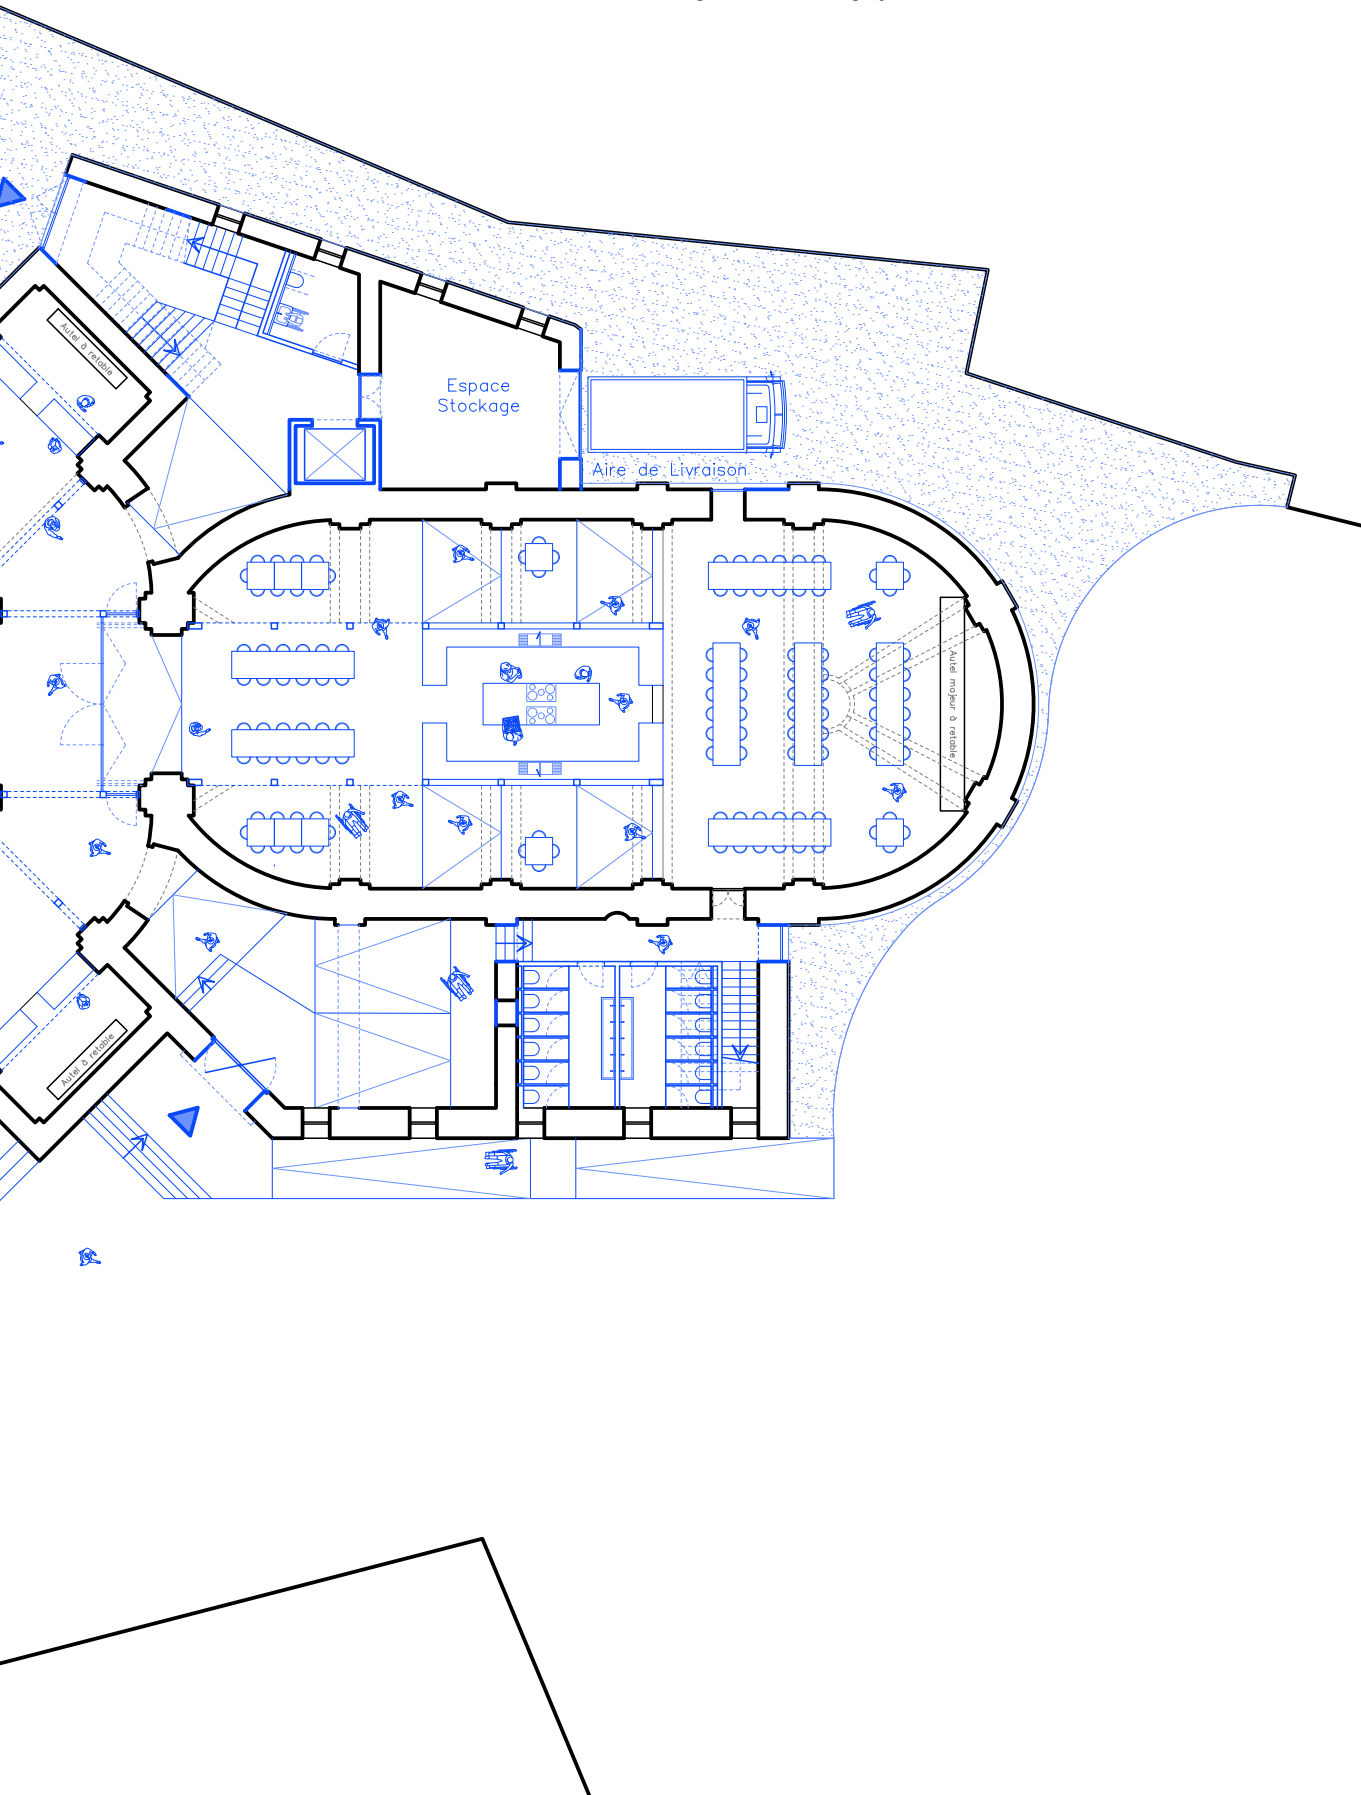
Situation projetée - Plan du Rez de chaussée, 1/250°
